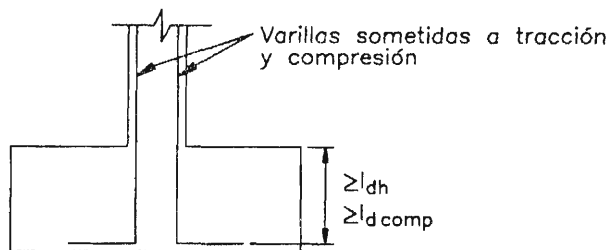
Peralte de la zapata requerido para garantizar el adecuado anclaje del refuerzo de la columna
